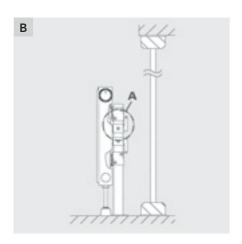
Heizkörper mit montiertem Plan-Strahlungsschirm.
